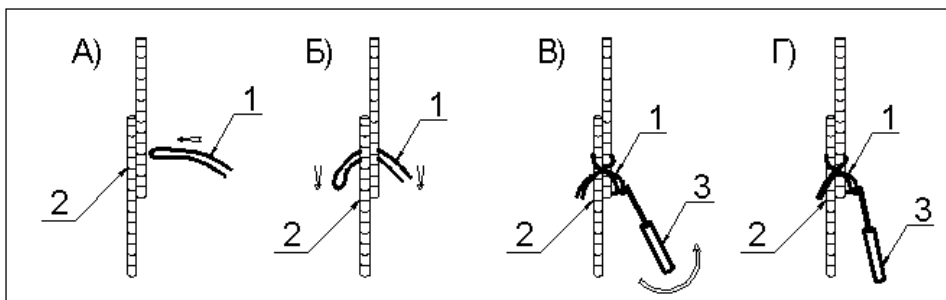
Схема фиксации вертикальных арматурных стержней вязальной проволокой.
